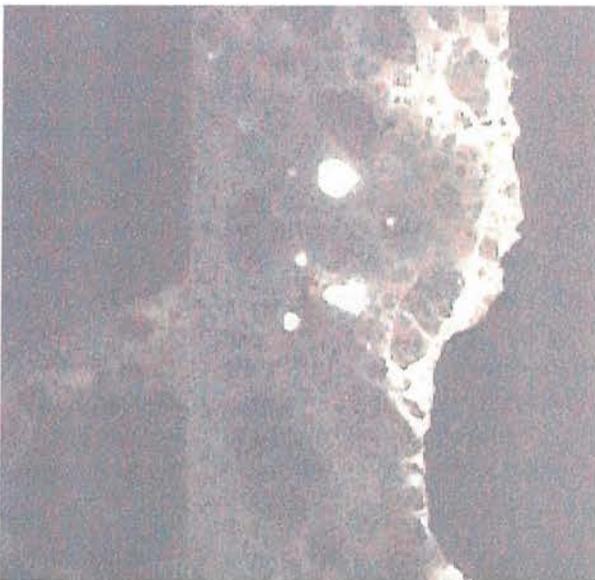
b: Beton nach Zugversuch an einer Stabstahlverankerung, Detailaufnahme
